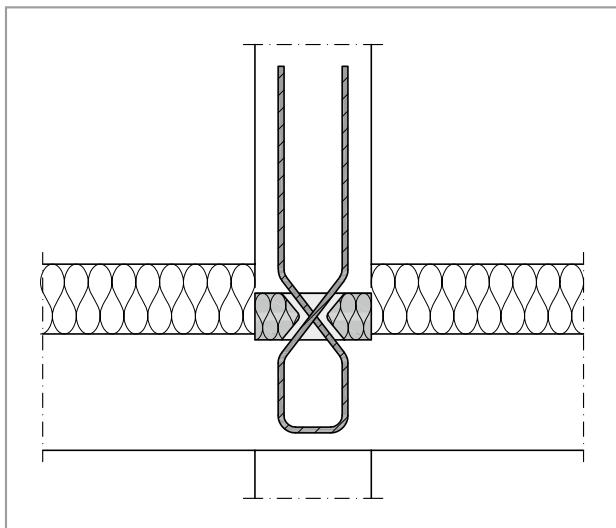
Schöck Sconnex® type W-N-VH: Section C-C, internal wall; above-slab insulation
